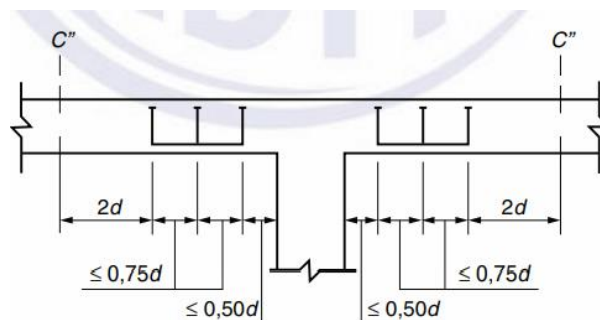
Disposição das armaduras de cisalhamento (NBR 6118, 2014)
